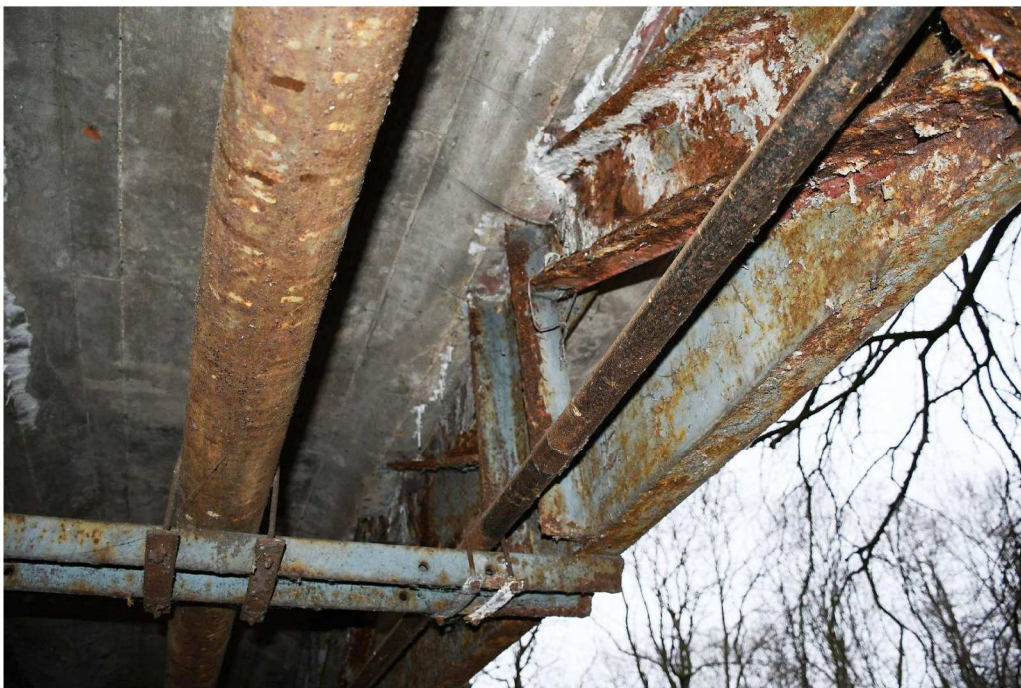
Wspornik podchodnikowy, konstrukcja stalowa
